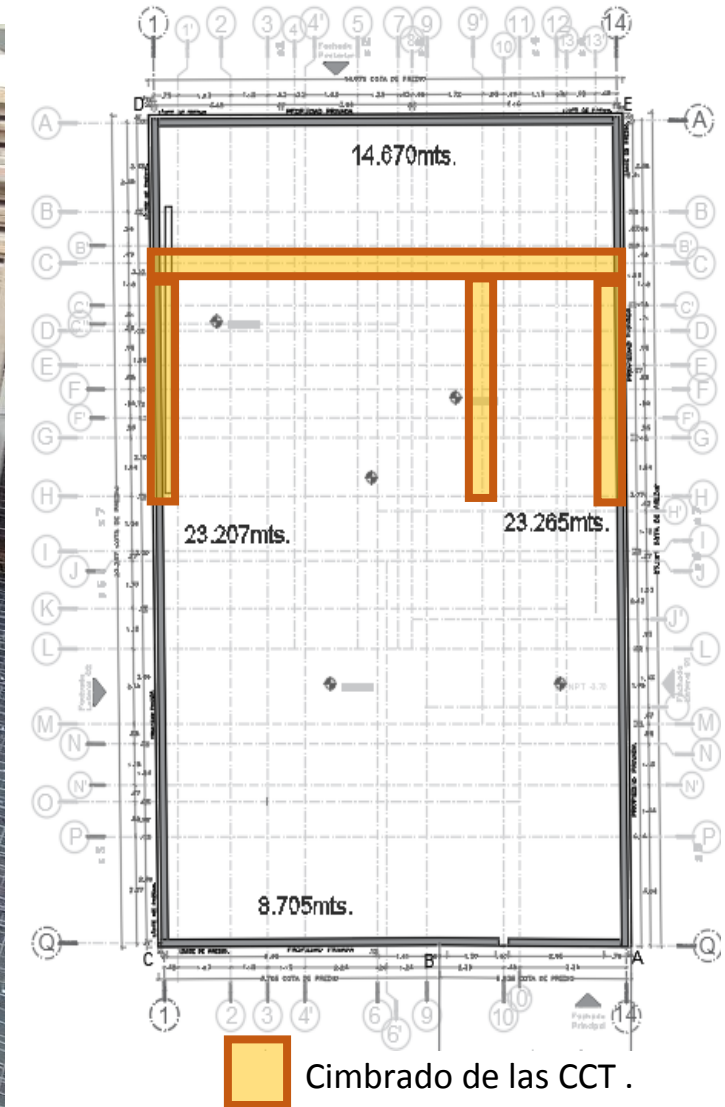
Cimbrado de CCT 1, 9 y 14.
